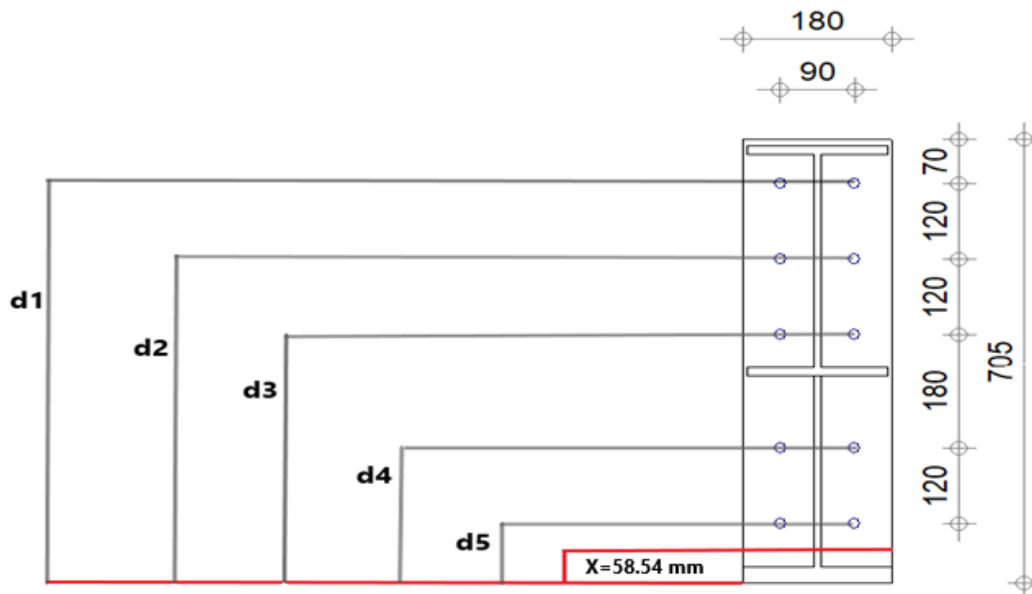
la hauteur de la zone comprimée (Assemblage traverse -traverse).
